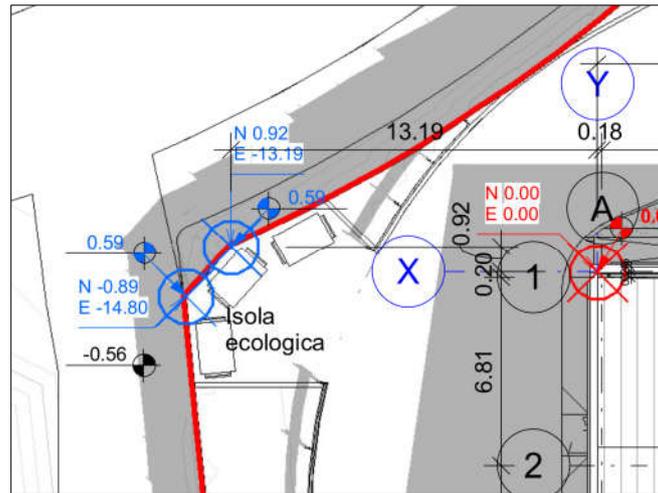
Estratto di planimetria – posizione isola ecologica / area rifiuti
